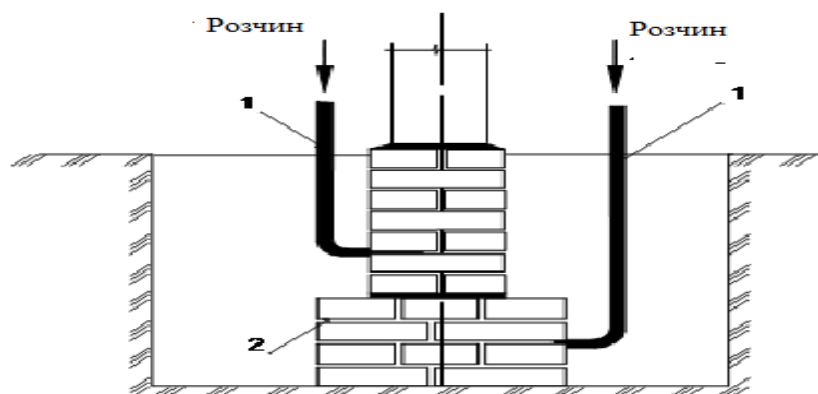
Зміцнення кладки старого фундаменту:
